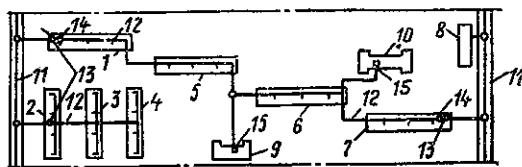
Фрагмент плана микрорайона с водопроводной сетью
